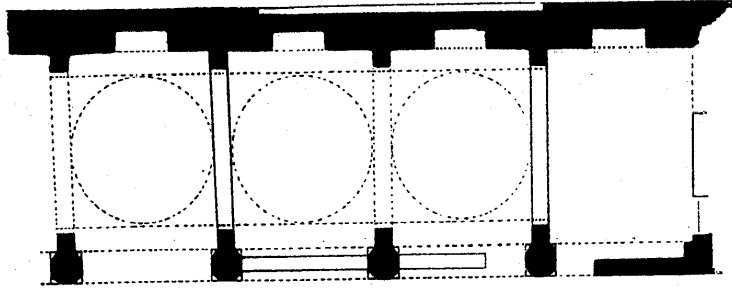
مسقط أفقي لمدفن كل من محمد بن سلامة العراقي وزين الدين العراقي
